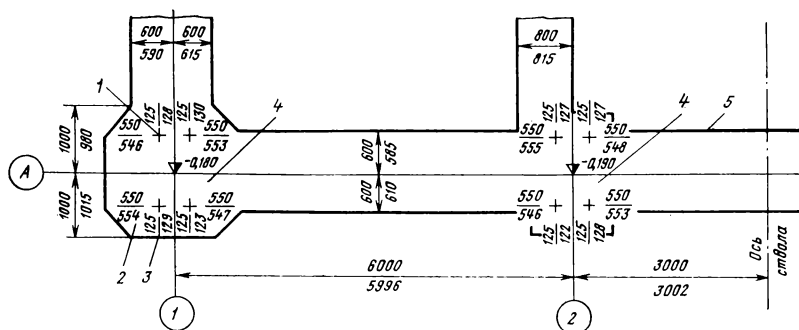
Пример исполнительной схемы части фундамента под металлический башенный копер:
